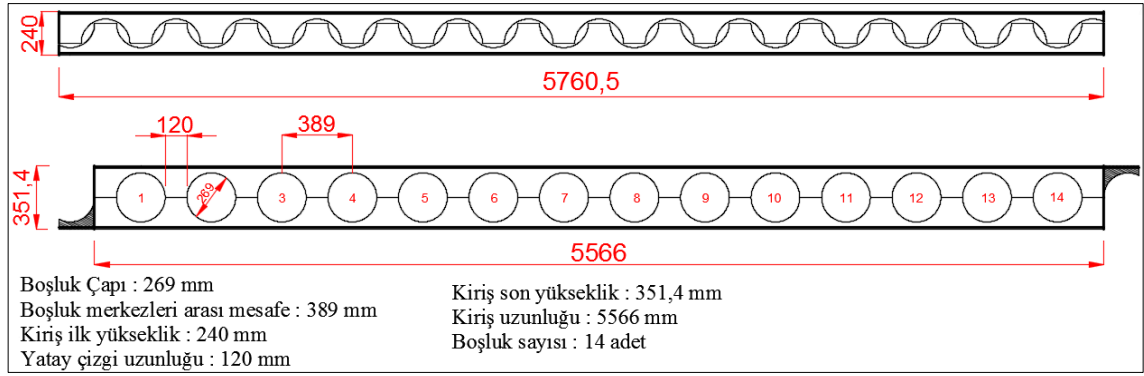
IPE 200 petek boşluklu çelik kiriş (IPE_PB_200) detayı
